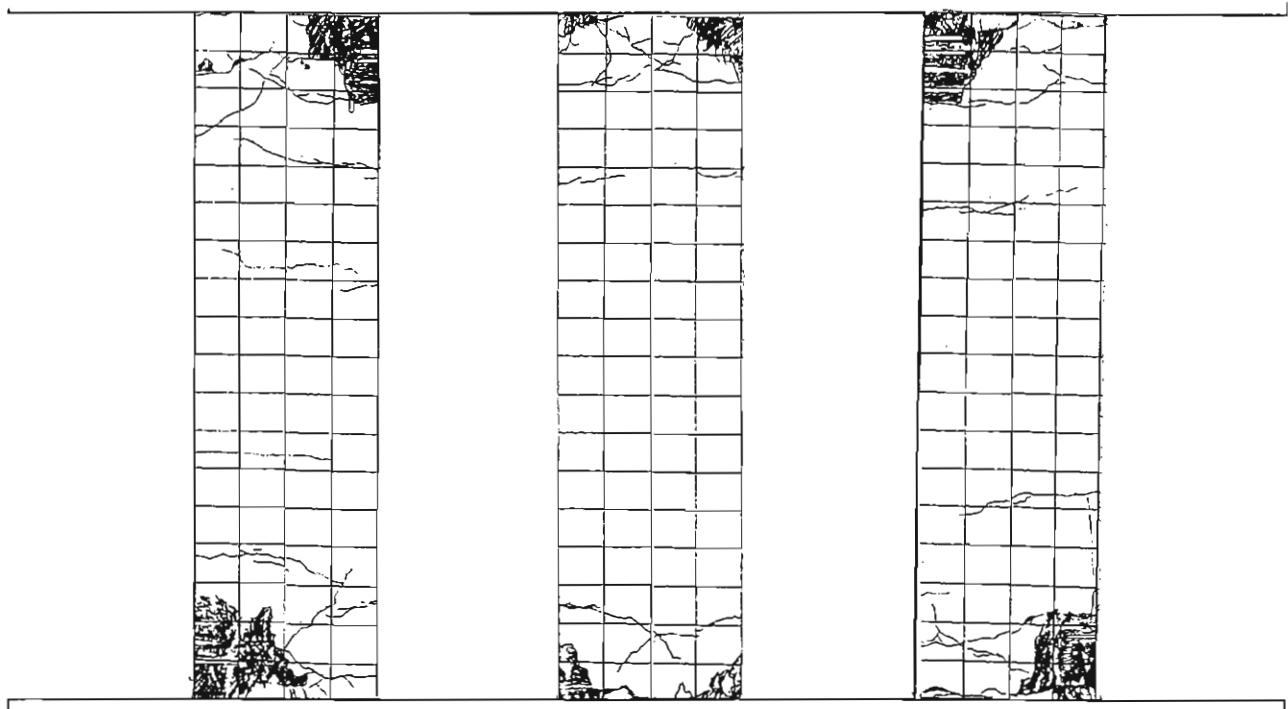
1. 29 桁体のひび割れ状況展開図（ケース 4、6 δy）
